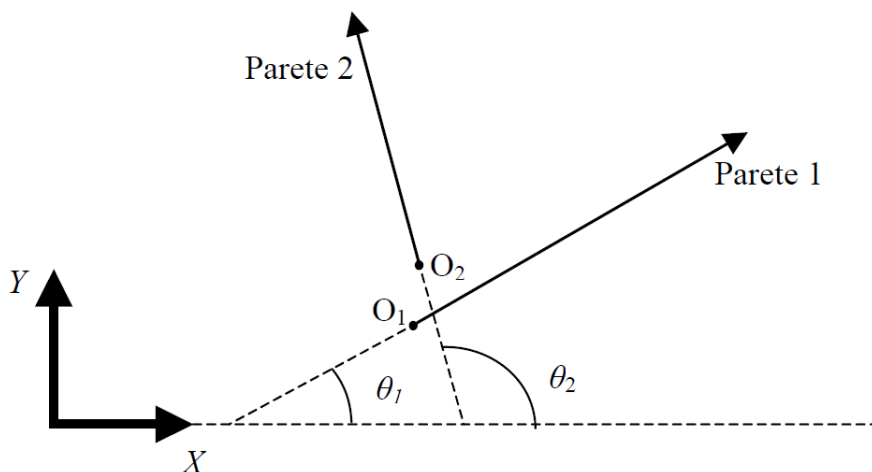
Individuazione in pianta della traccia delle pareti
